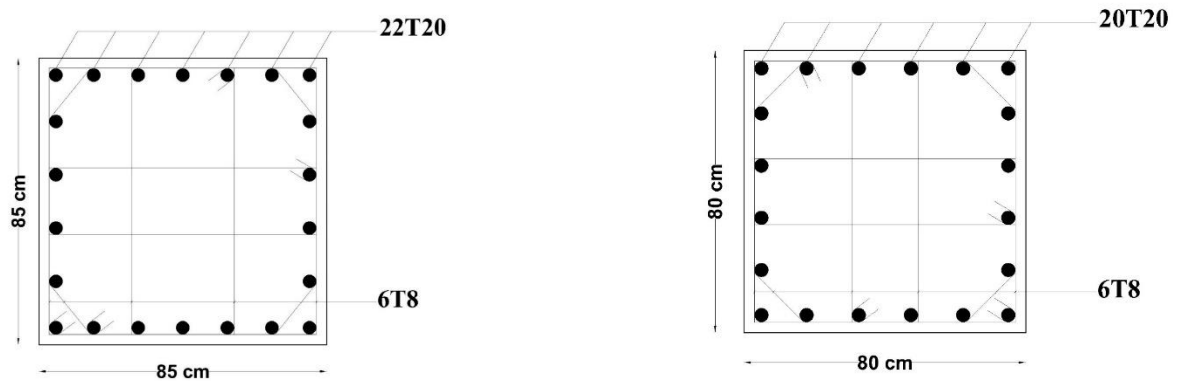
Schéma de ferrailage des poteaux (85x85) et (80x80)
